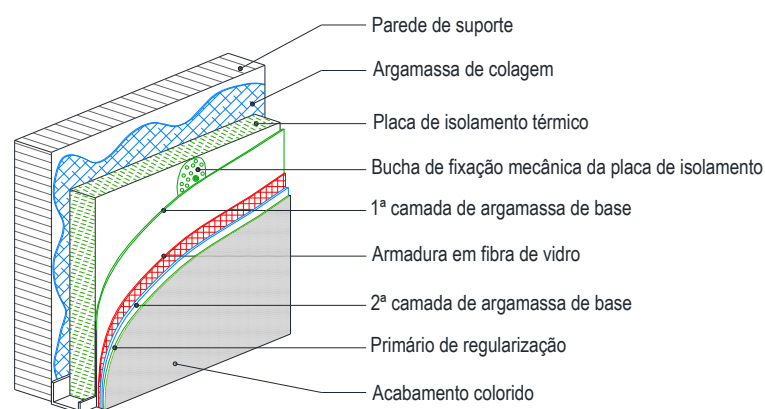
Pormenor construtivo do sistema ETICS (adaptado de [57]).
